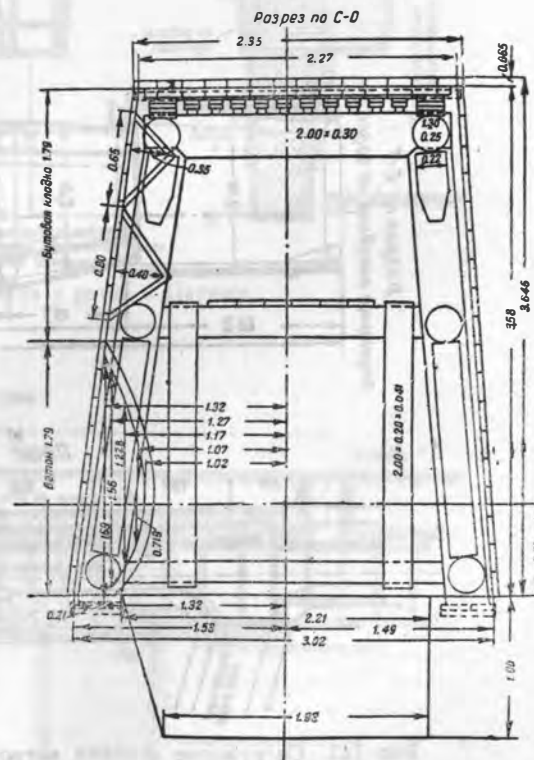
Конструкция крепления штольни для закладки стены станции „Буль де Бельвиль“ под домом.
